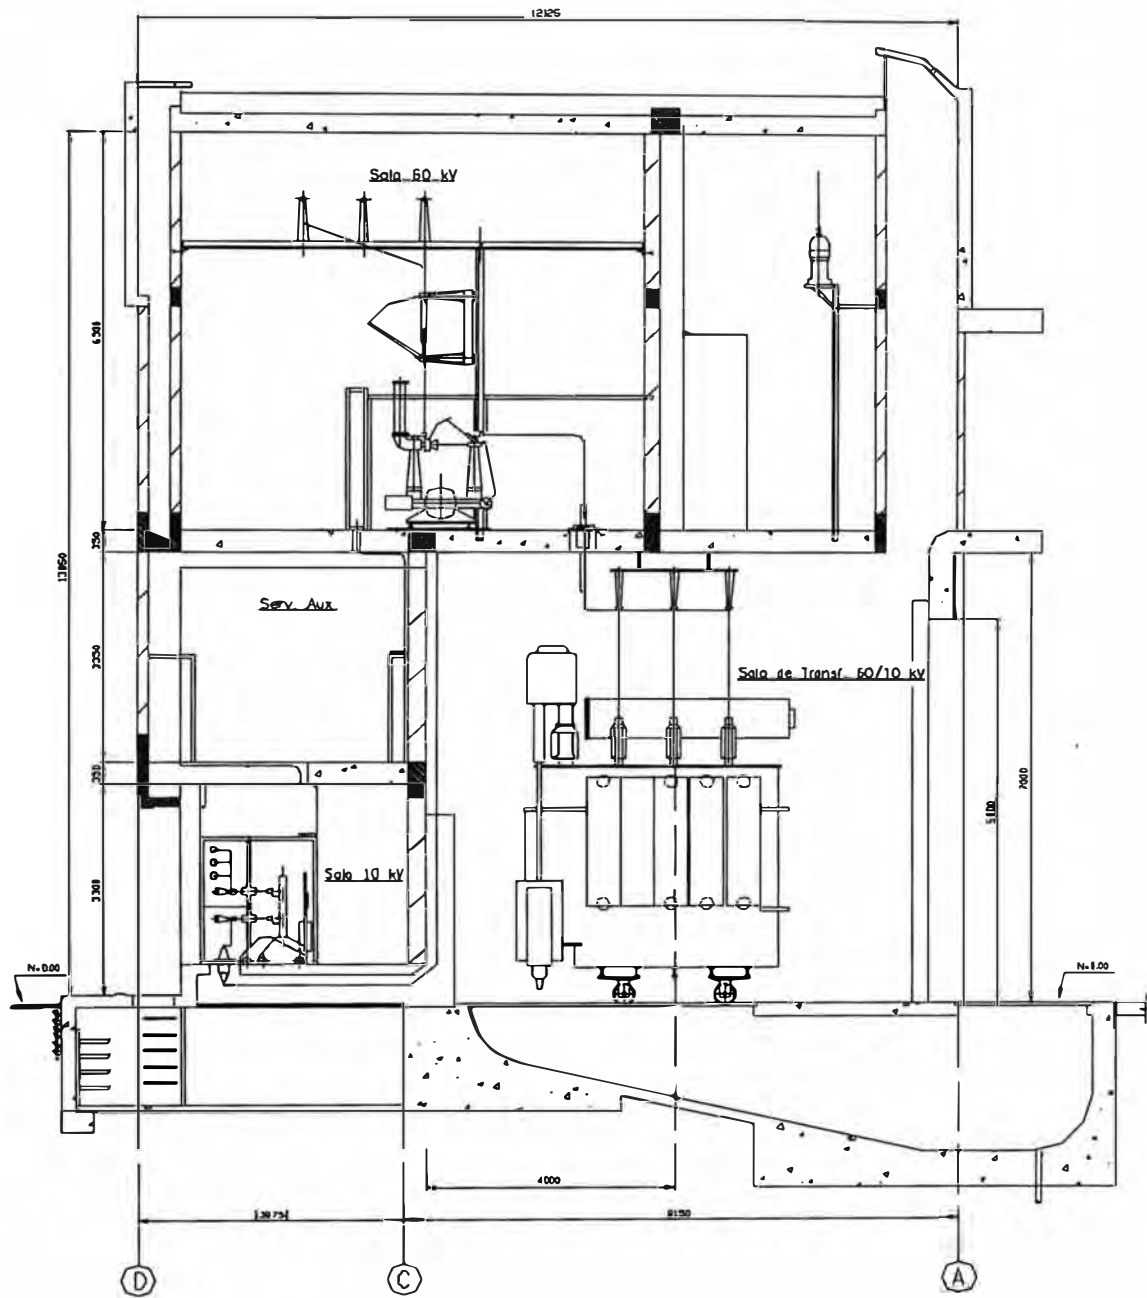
Vista transversal de una subestación AT/MT tipo interior
